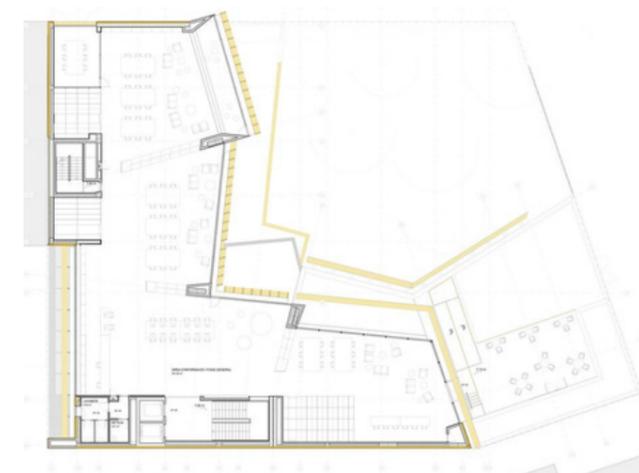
Segundo Piso Biblioteca Pilarín Bayés
